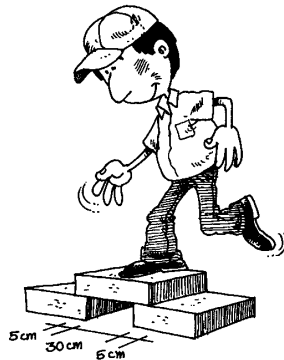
Prueba de resistencia de los bloques de adobe, Fuente: Manual de Construcción con Adobe Reforzado con Geomallas.[32]
